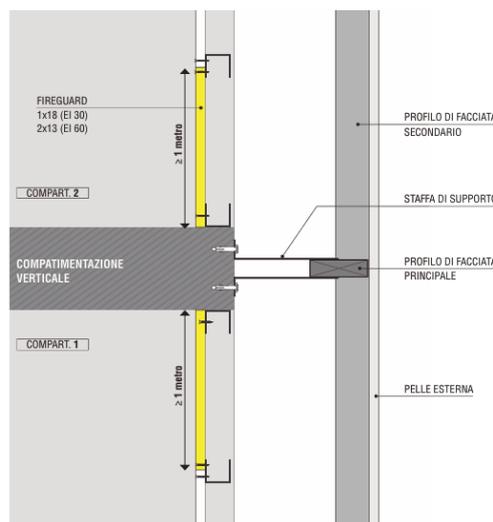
Fascia di separazione verticale – Vista in pianta (Building)
